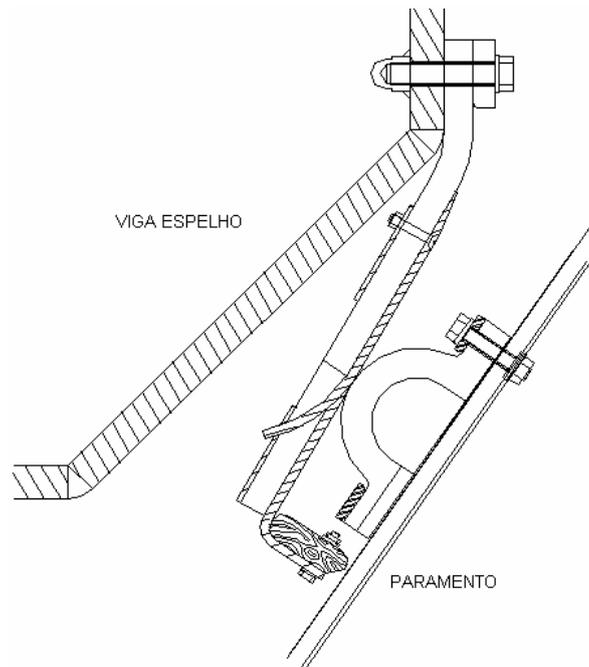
Corte mostrando o sistema de vedação entre a viga espelho e o paramento da comporta
